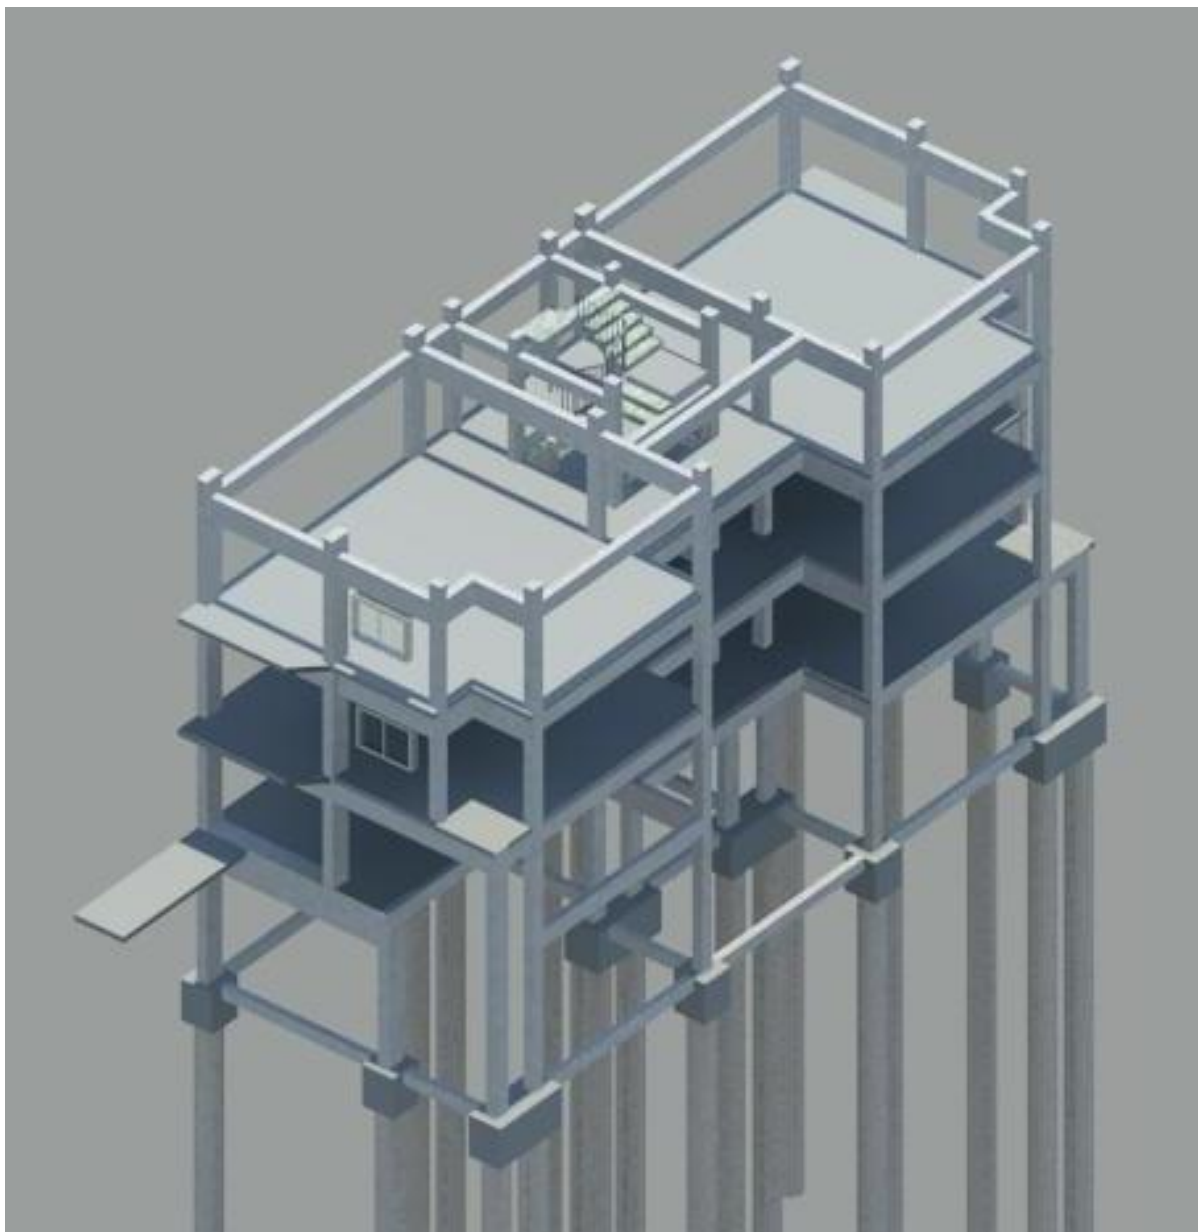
Perspectiva da estrutura do edifício com destaque para o terceiro pavimento
